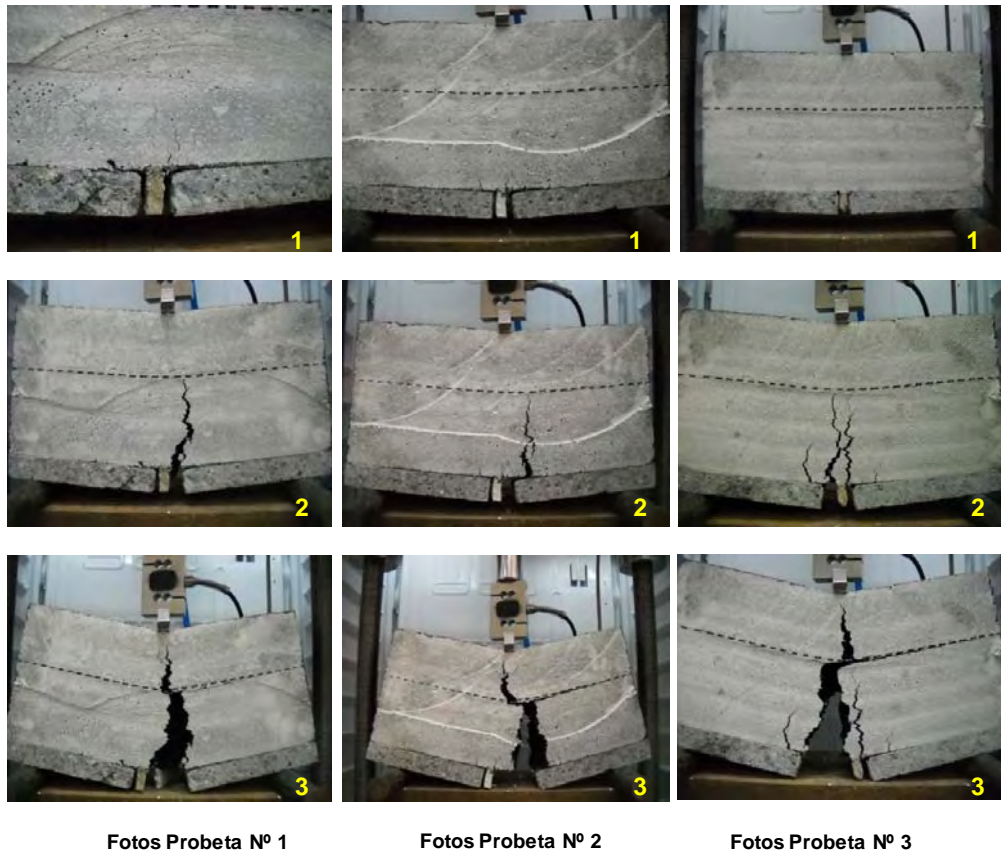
Secuencia de fisuración para la probeta 1, probeta 2 y probeta 3 para el Sistema 1
